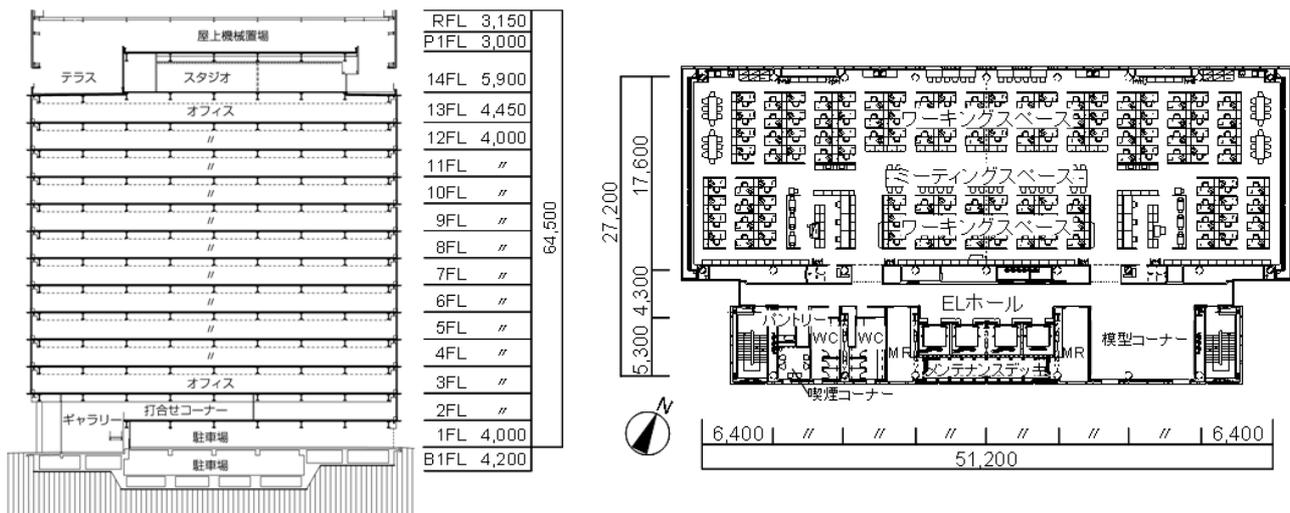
Aビルの断面図（左）と基準階平面図（右）
